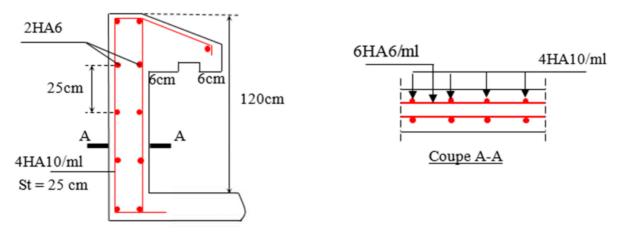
Schéma de ferraillage de l'acrotère.
